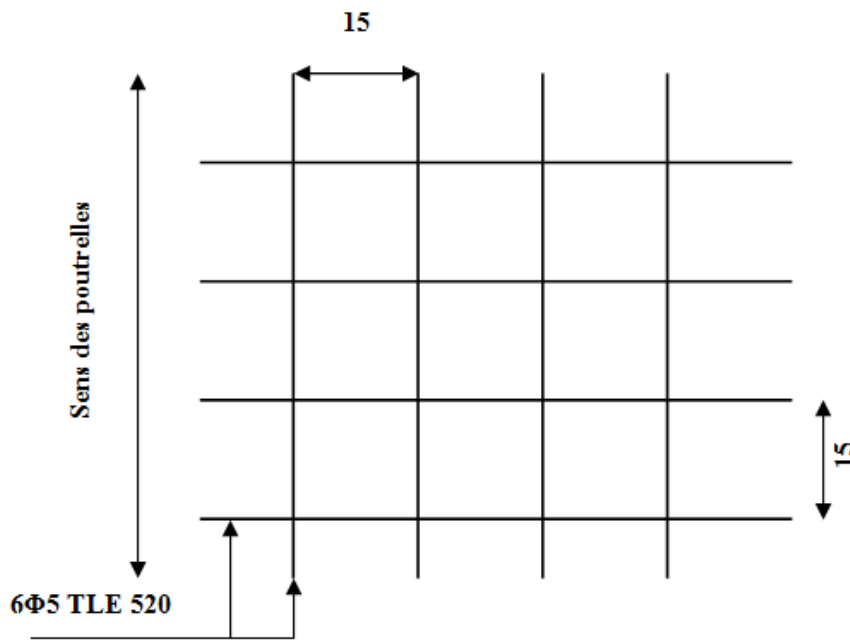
Schéma Armatures parallèles aux poutrelles
